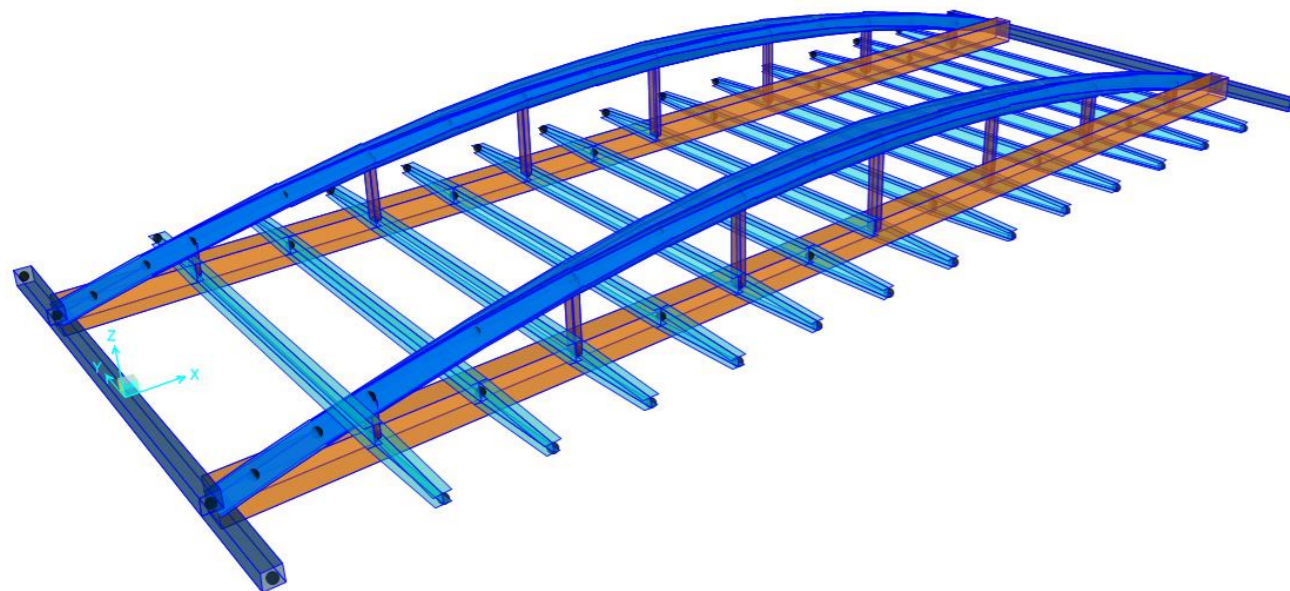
Vista general de la estructura (Fuente: Elaboración propia)
